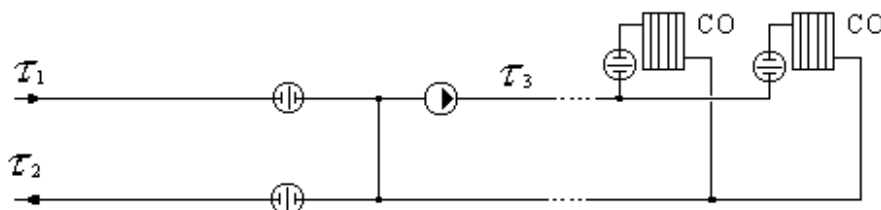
Схема ЦТП (ИТП) с насосом смешения на подающем трубопроводе
